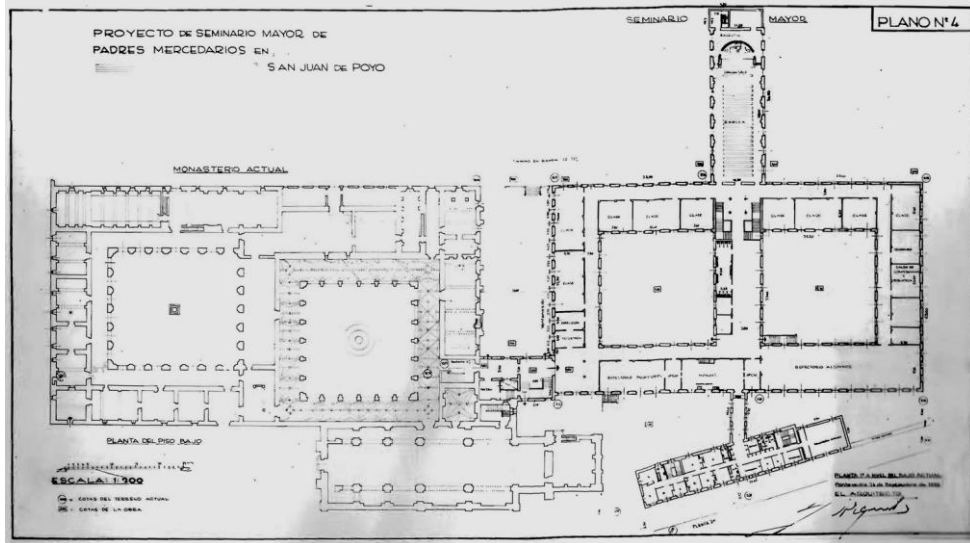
Planta Baja. Fuente: Archivo Provincial.
